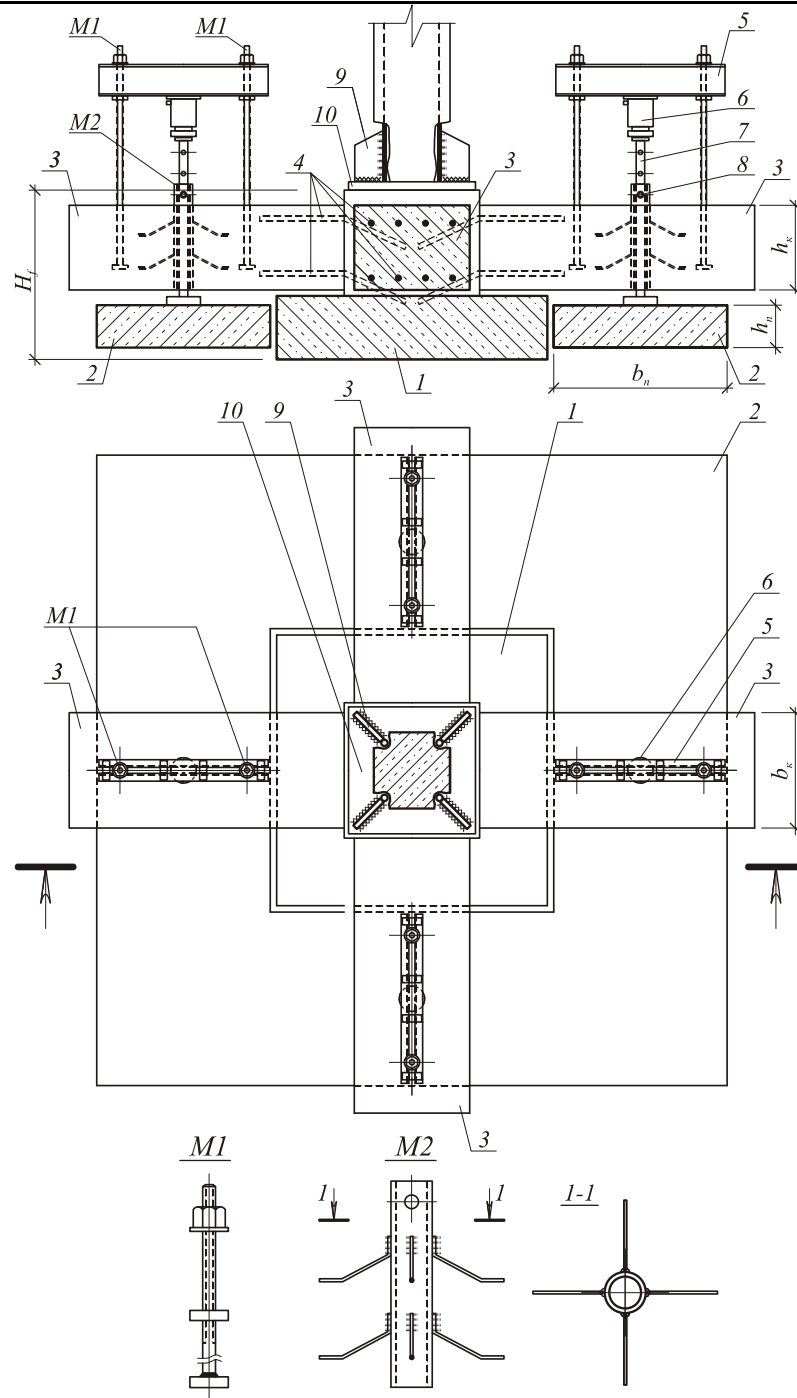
Устройство для усиления фундамента с обжатием грунта основания
